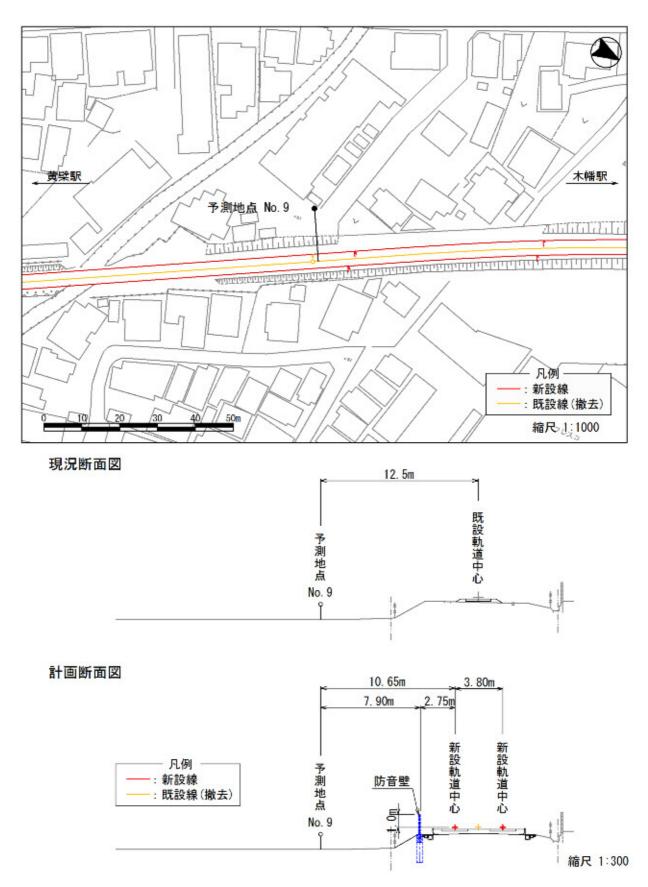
(9) 予測平面·断面図(予測地点 No.9)
